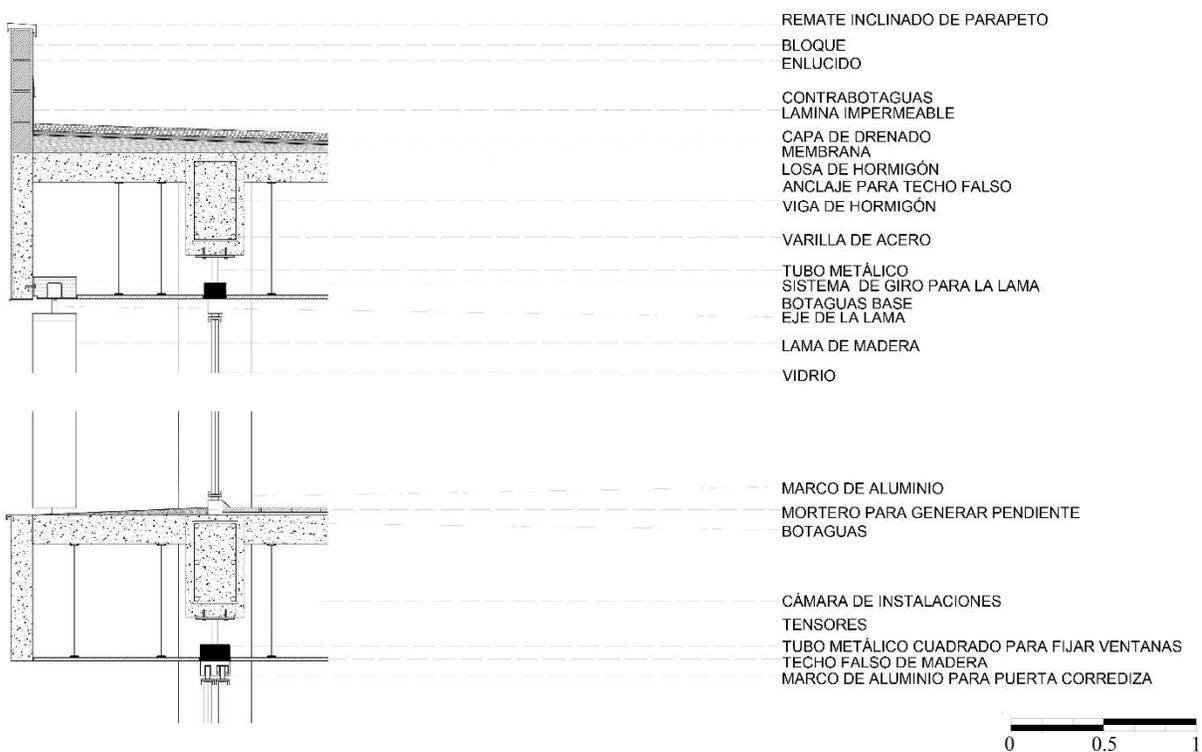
Detalle Constructivo de Fachada. Autoría propia.
